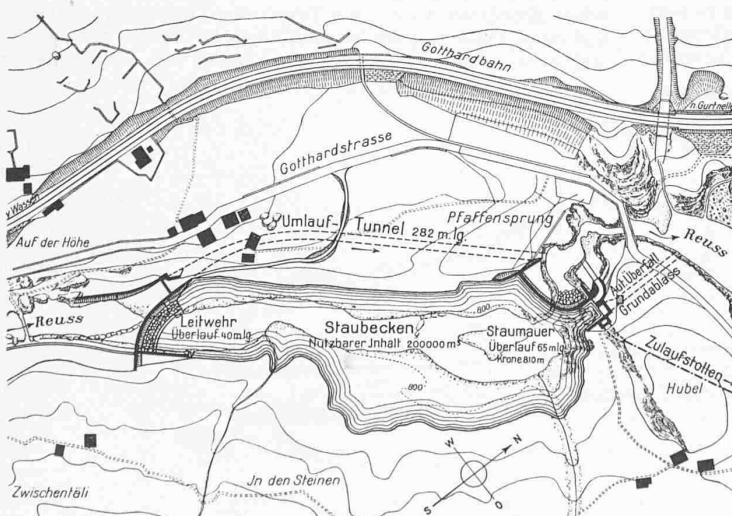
Lageplan 1:5000. — Bew. 6057, 21. Juni 1942 lt. BRB 3. Okt. 1939
